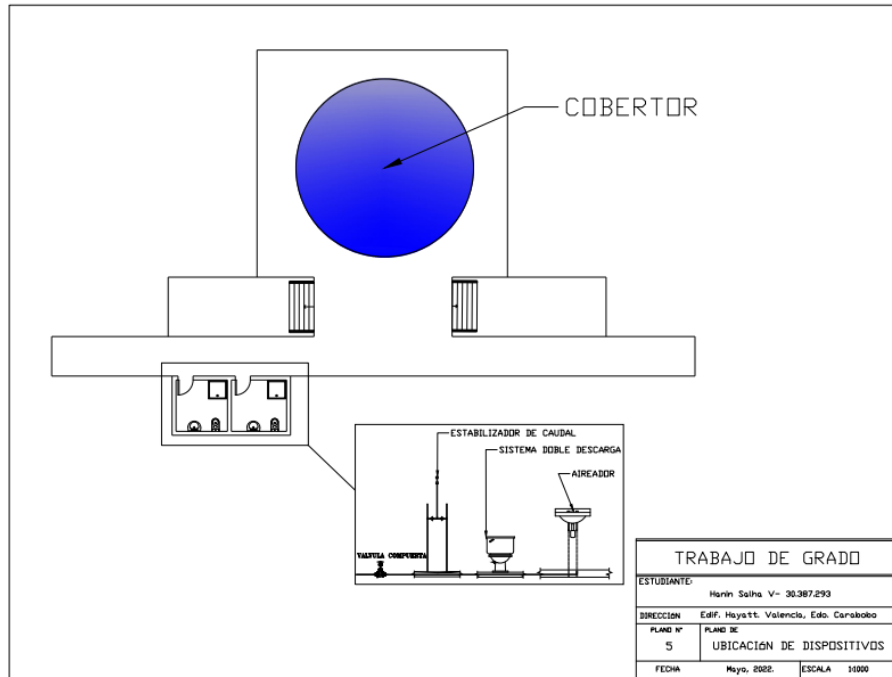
Ubicación de dispositivos en la planta baja (Caso estudio).
